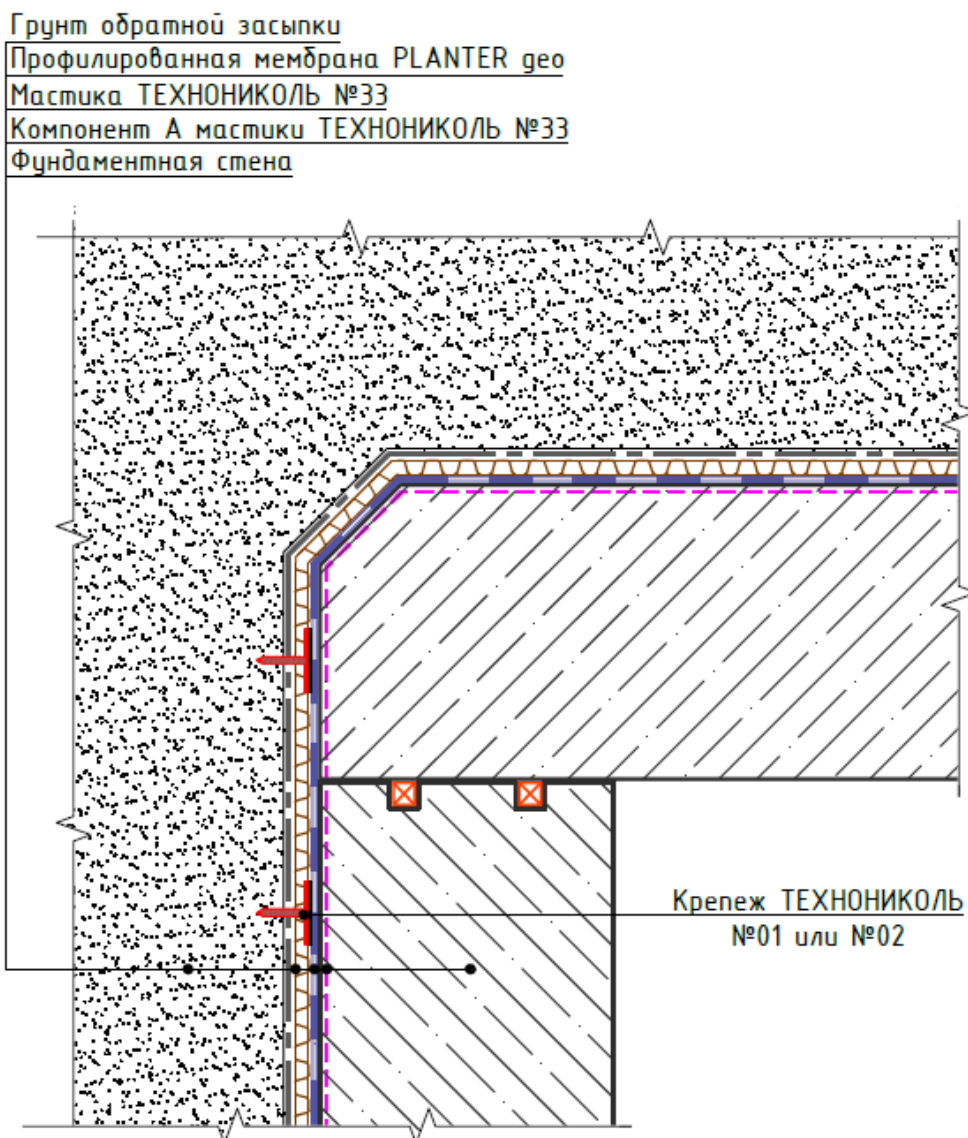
Гидроизоляция перекрытия тоннеля (внешний угол конструкции)
